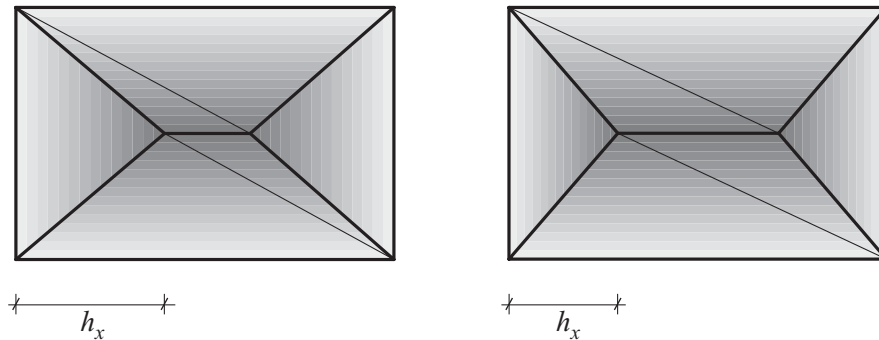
Beispiel 4: Orthotrop bewehrte Stahlbetonplatte nach PARDEY [111]
